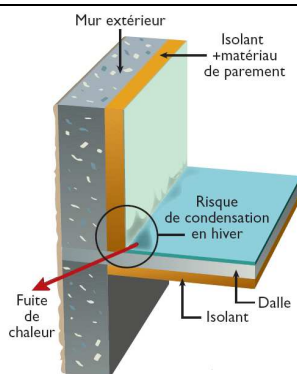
PONT THERMIQUE D'UN PLANCHER
